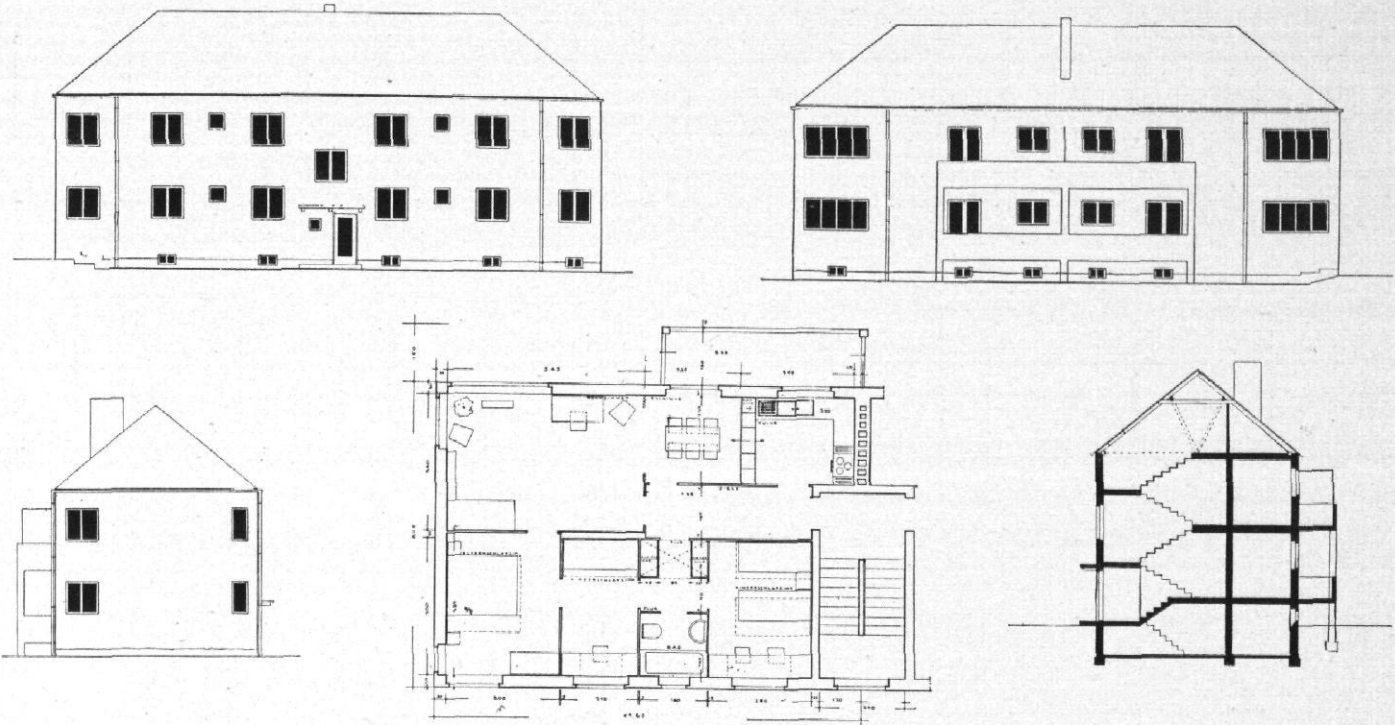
bis 16 / Großsiedlung Bad Dürrenberg / Architekt: Alexander Klein, Berlin / Doppelhaus Typ C 7 / Ansichten, Schnitt und Grundriß 1 : 300
